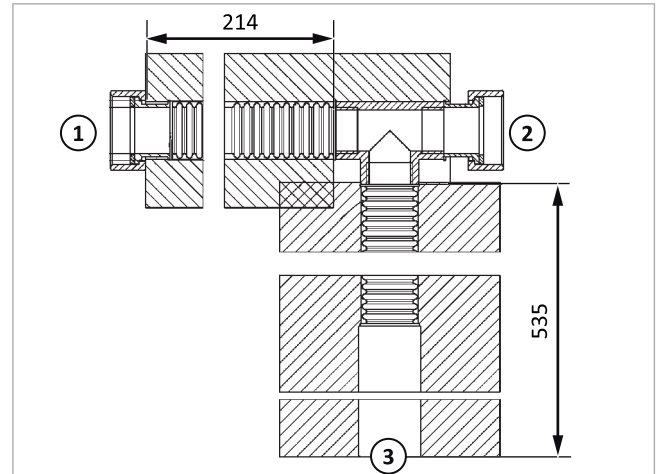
tuyau de raccordement de la chaudière à combustible solide FBK (RO-FBK-RL)
